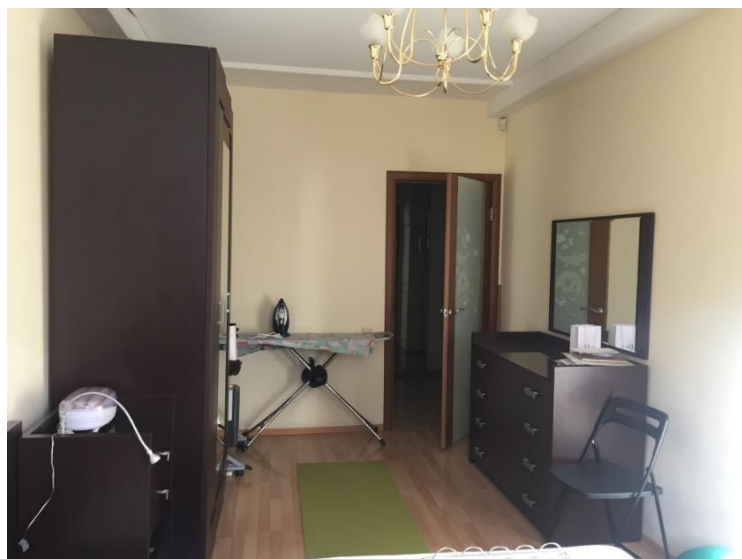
Фрагмент вида помещения № 6 (Жилая комната).
